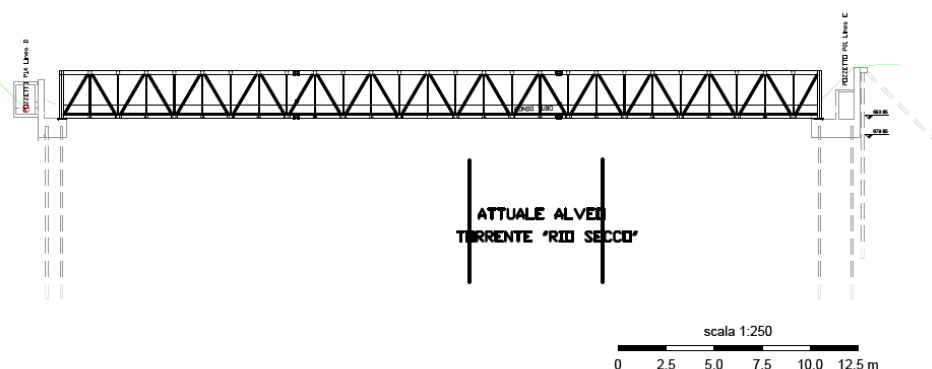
Sezione longitudinale attraversamento aereo di progetto sul Rio Secco.
